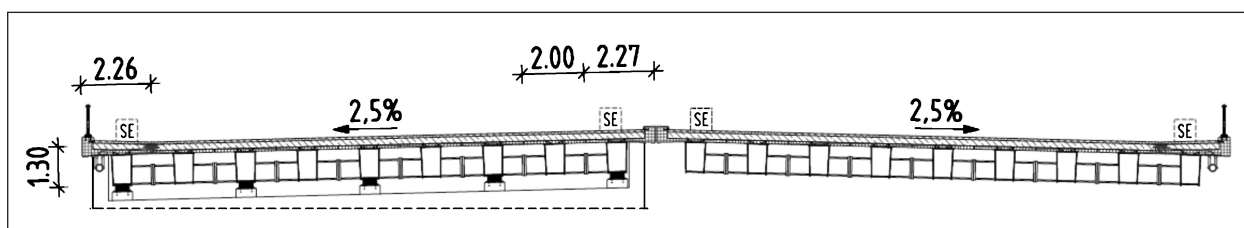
Stahlverbundträger Trägerschar, mit Ortbetonerfüllung und integriertem Gesims
